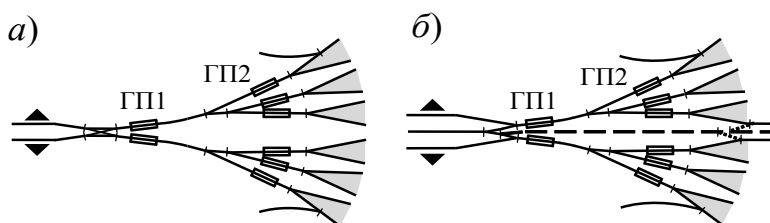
Рекомендовані схеми конструкцій колійного розвитку спускної частини ГВП.
